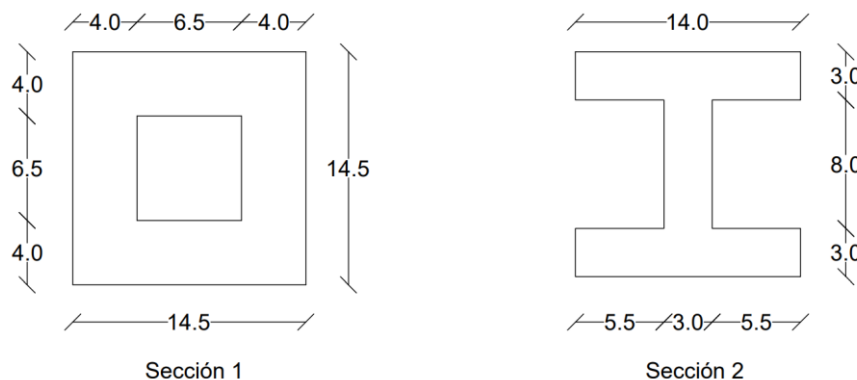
Posibles secciones. Dimensiones en centímetros (cm).
